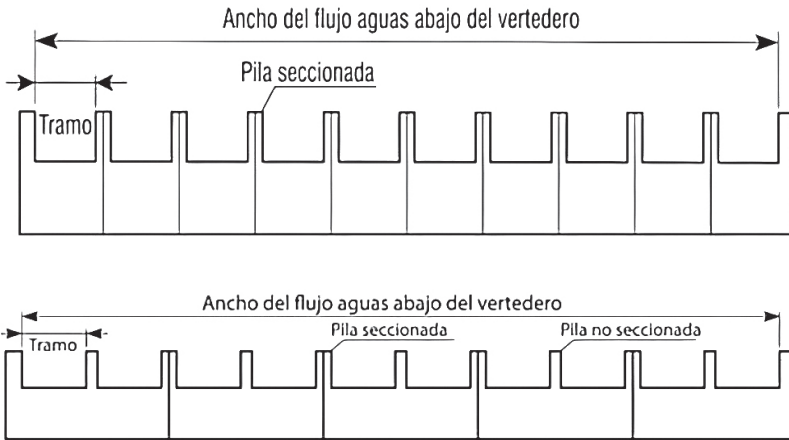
División de la presa en secciones con juntas de asentamientos.
